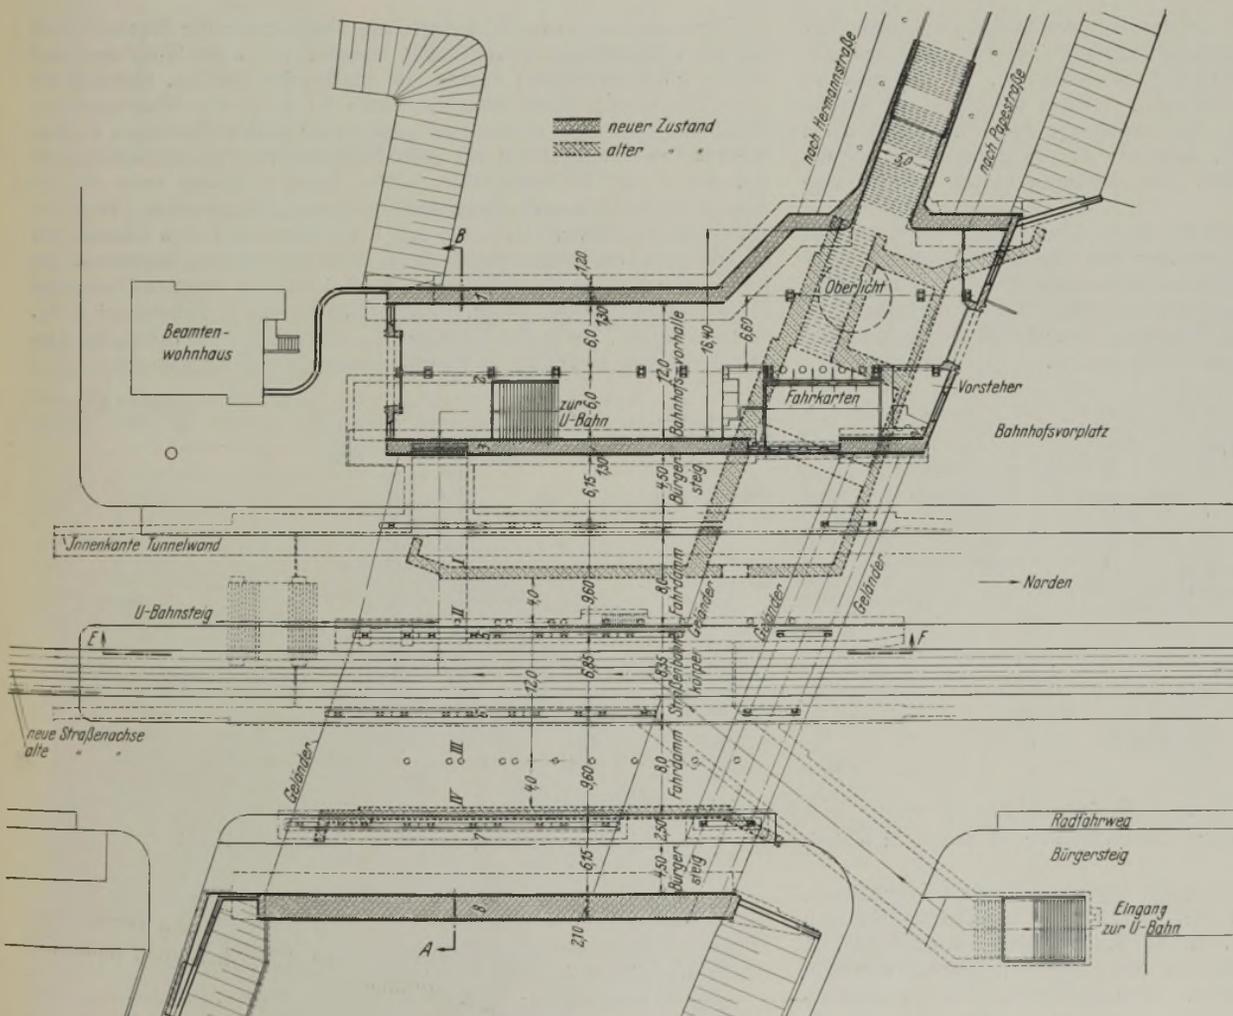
Grundrisse der alten und neuen Unterführung mit den Empfangsgebäuden.
